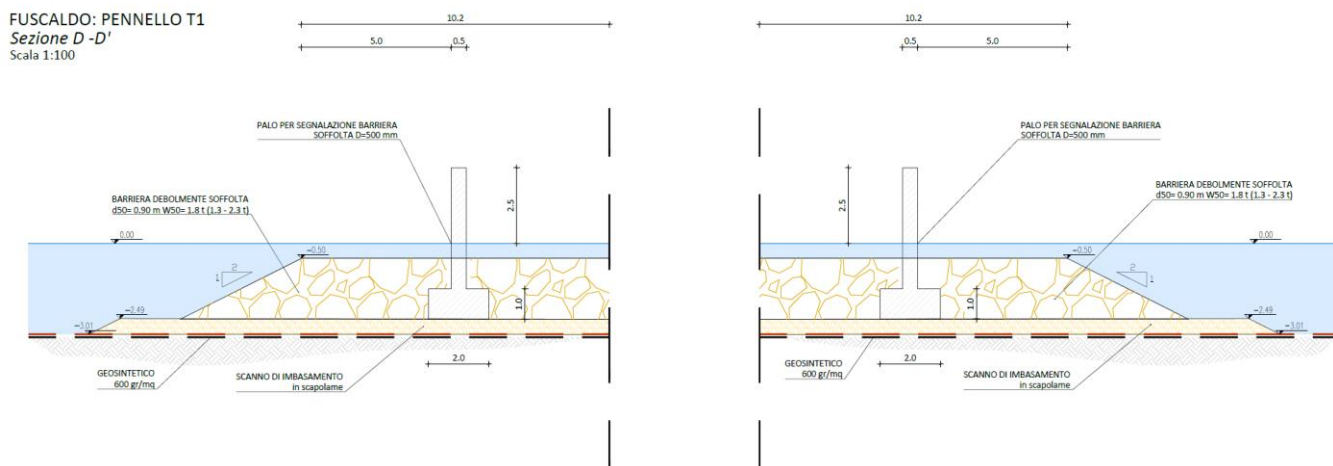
Stralcio trasversale barriera a cresta bassa
